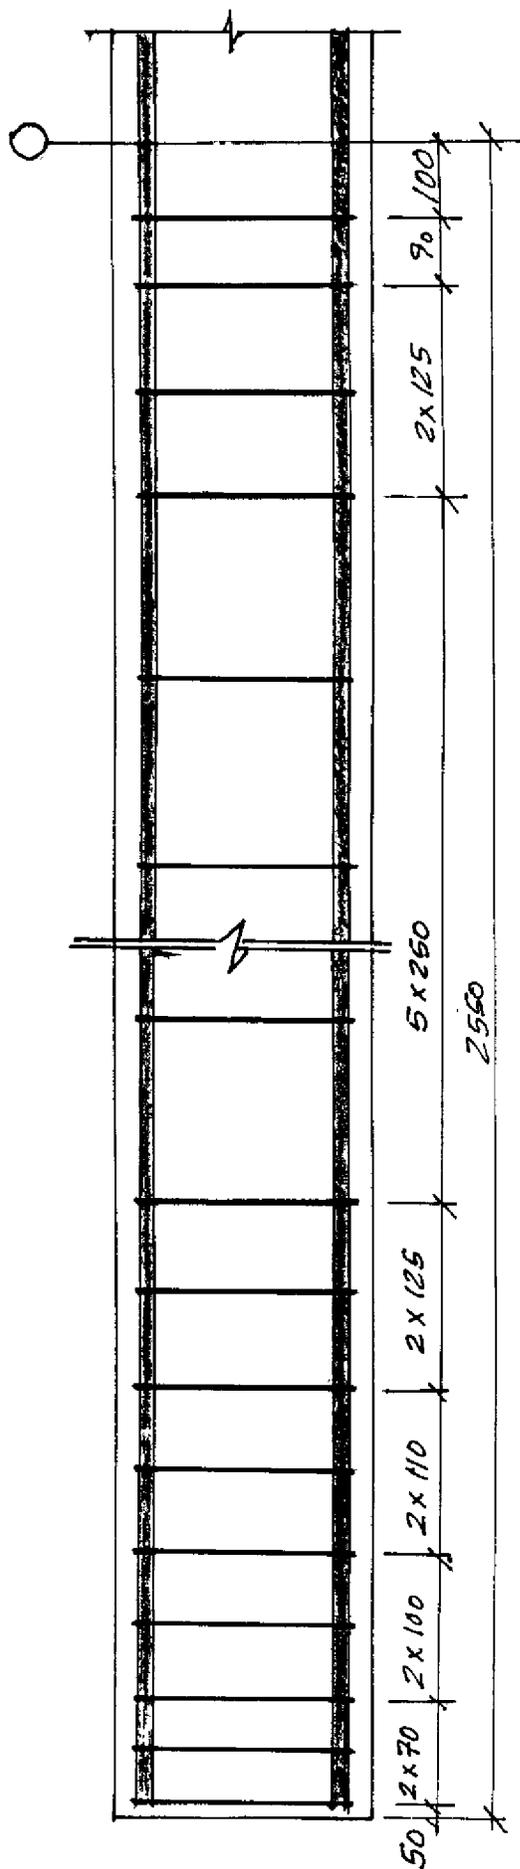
DETALLADO ACTUAL DE LOS ACEROS DE LAS COLUMNAS DEL SISTEMA I.M.S.
